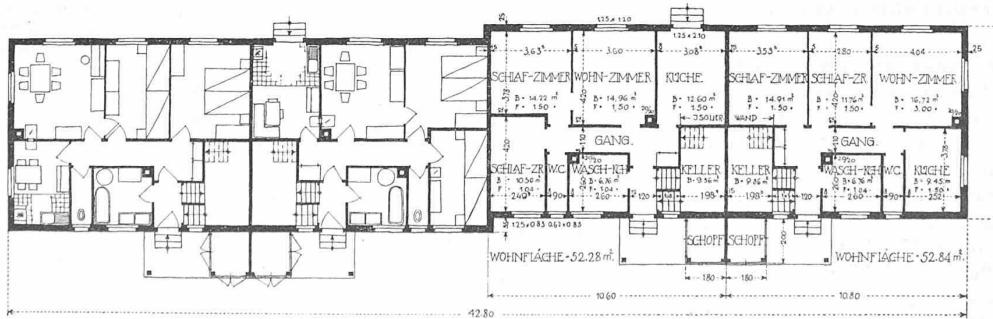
Grundrisse der Dreizimmerwohnungen. — Architekten Kessler & Peter, Zürich. — 1 : 300.
